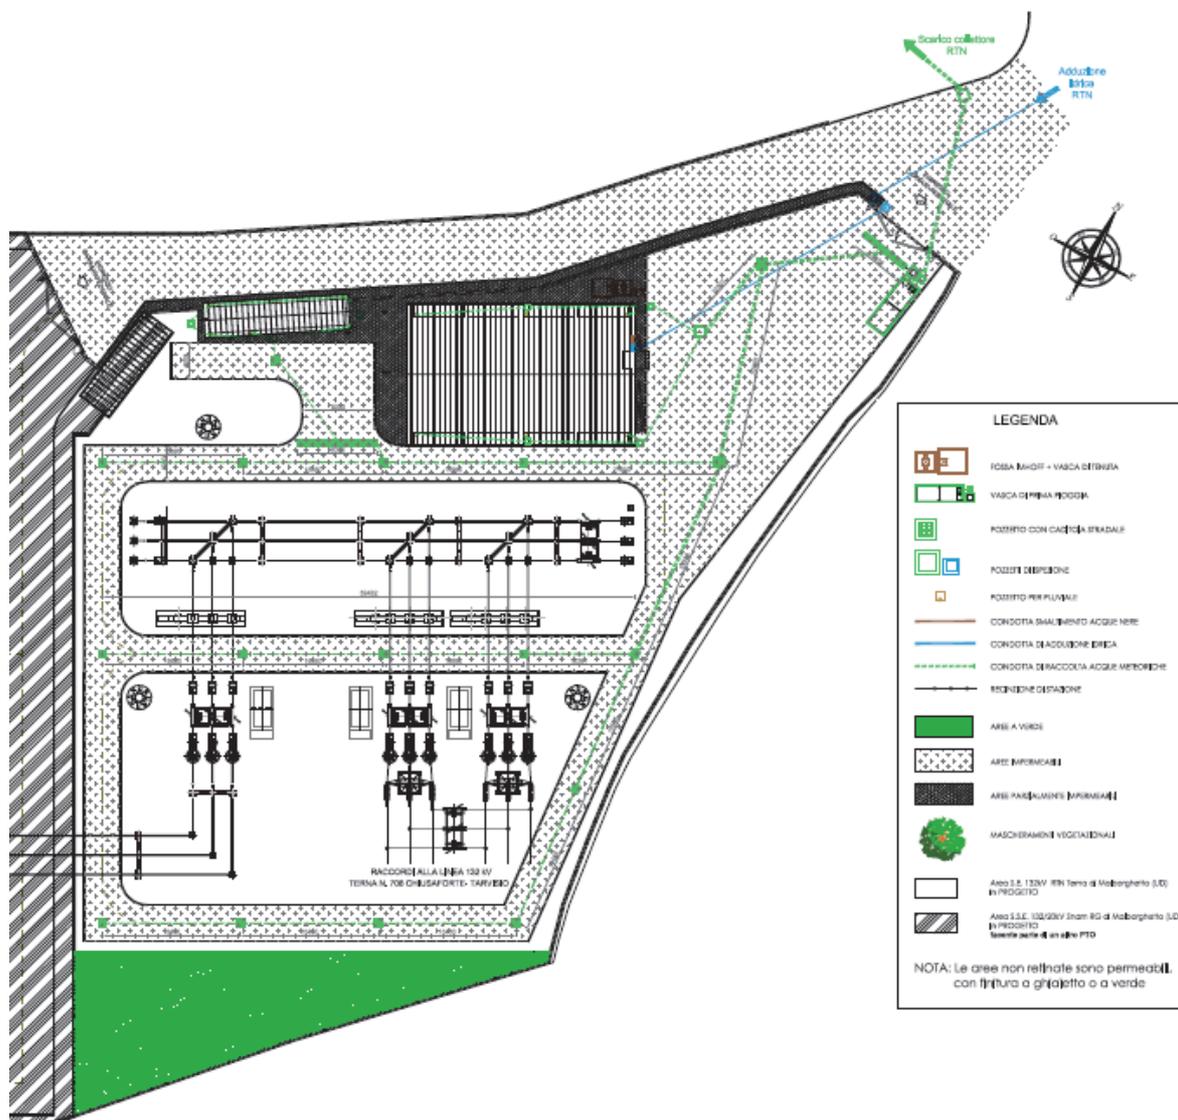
Planimetria Stazione elettrica a 150 kV di interconnessione alla rete di trasmissione nazionale - Terna
